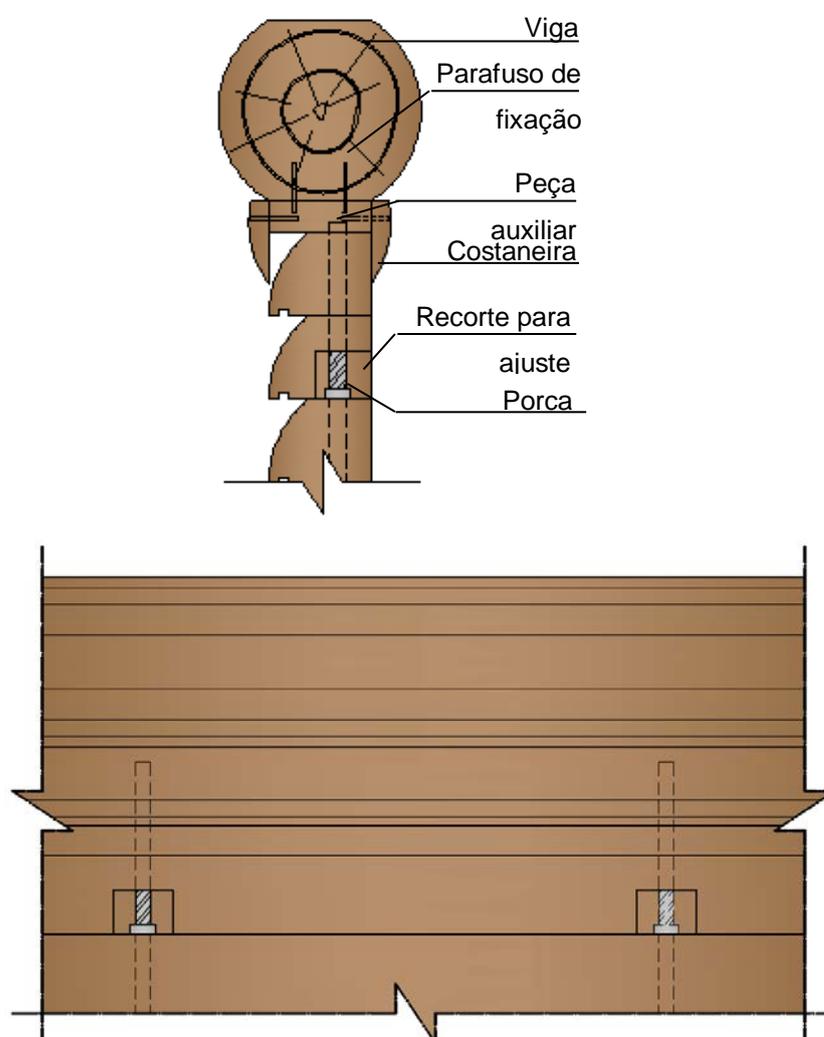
Detalhe de ligação entre módulo e estrutura. Acima, vista superior da ligação pilar-módulo e abaixo, corte vertical do módulo
